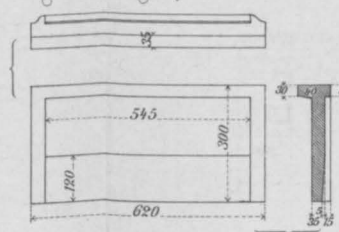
Brücke mit hochliegender Fahrbahn,
